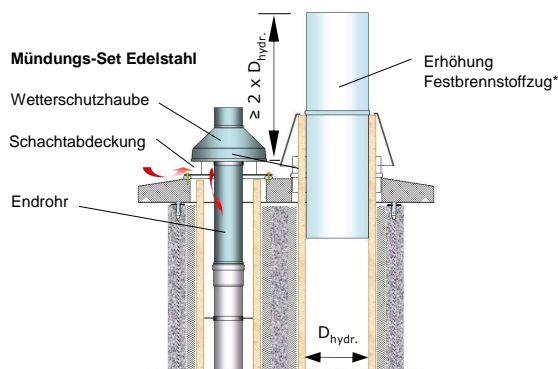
, Mündungsausführung einer Schornsteingruppe mit Festbrennstoffzug bei ru. Betriebsweise mit dem Mündungs-Set Edelstahl
